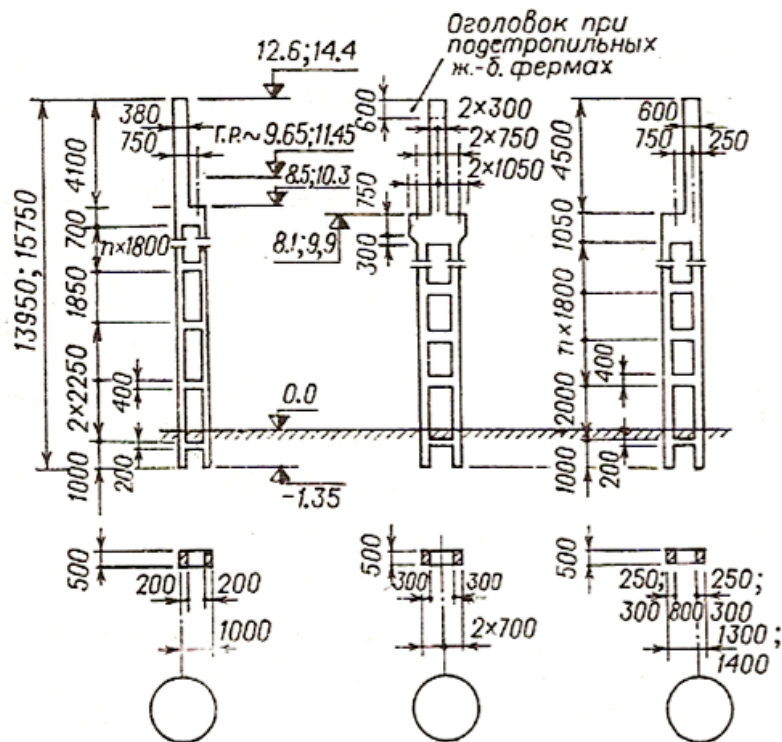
Типы двухветвевых железобетонных колонн для зданий с мостовыми опорными кранами
